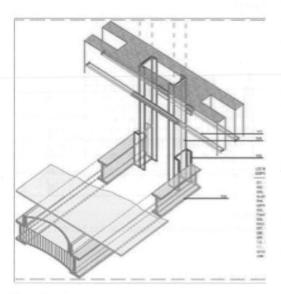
Nudo de unión entre la estructura del forjado de la planta sótano y el arranque de la estructura vertical de acero (dibujo de Esther García 2010)
